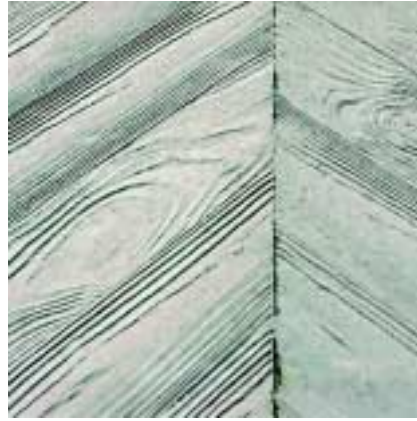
Strukturierte Betonoberfläche, Reckli-Strukturschalung Nr. 2/23 Alster, grauer Zement
